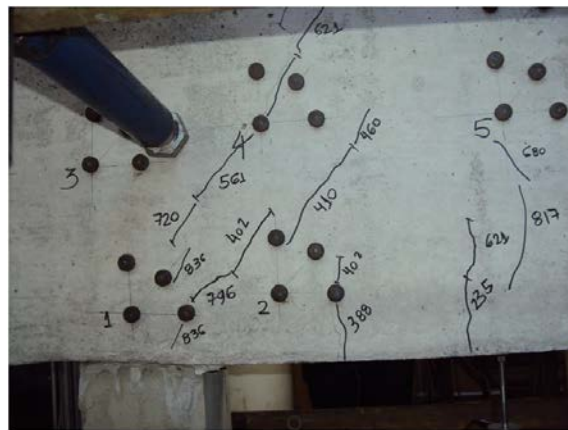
Fissuras iniciais no modelo B120P375R1
